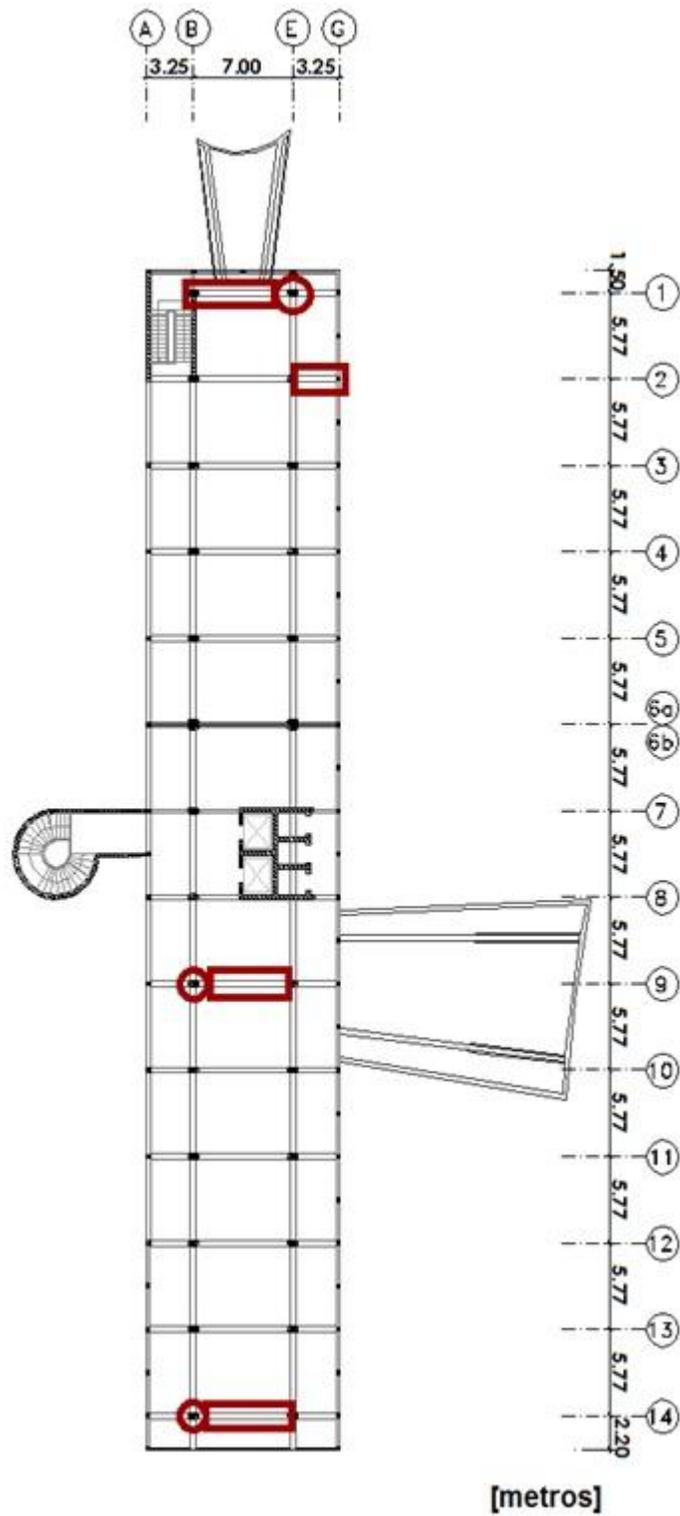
Elementos Estructurales de Planta Baja Ensayados.
